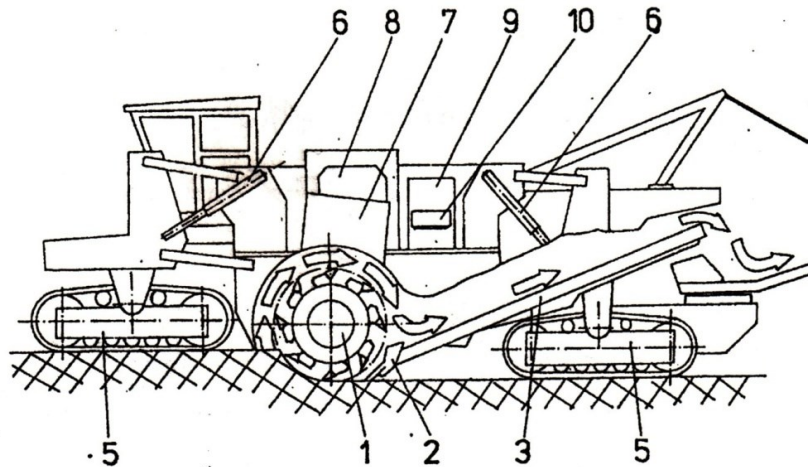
Principiální schéma SURFACE MINER fy Krupp
